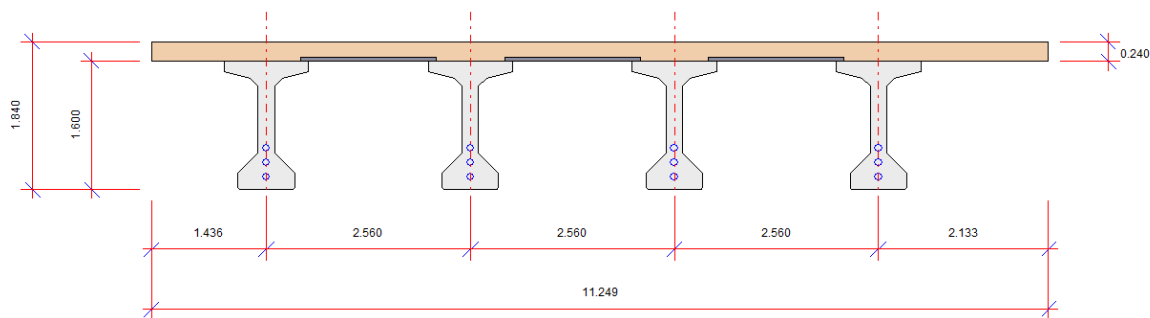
Figura 2. Sección tipo. Fuente: IDOM-DEHC.
